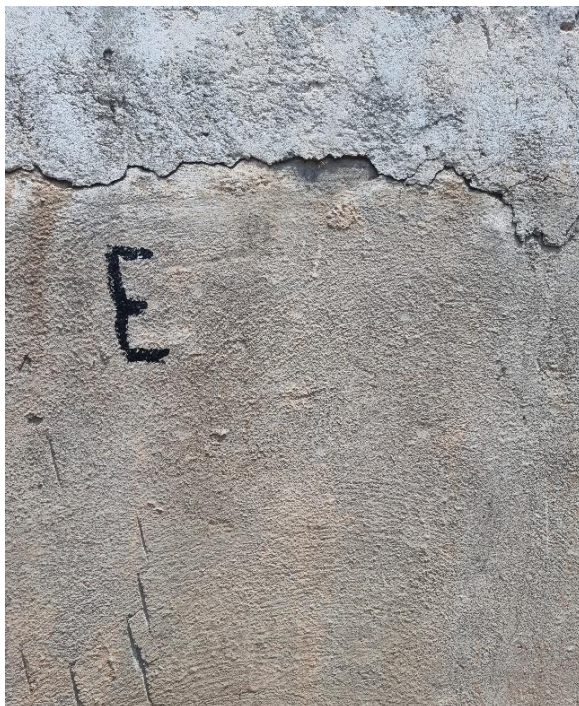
Muro de hormigón sobre el que se calibra el instrumento.
